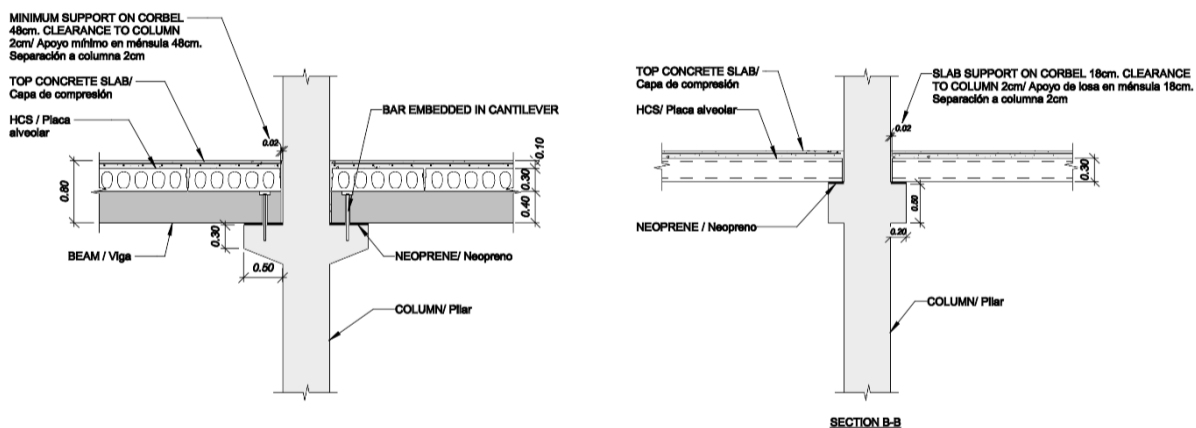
Esquema apoyo vigas en ménsula de pilar (Nota: las dimensiones son orientativas)
